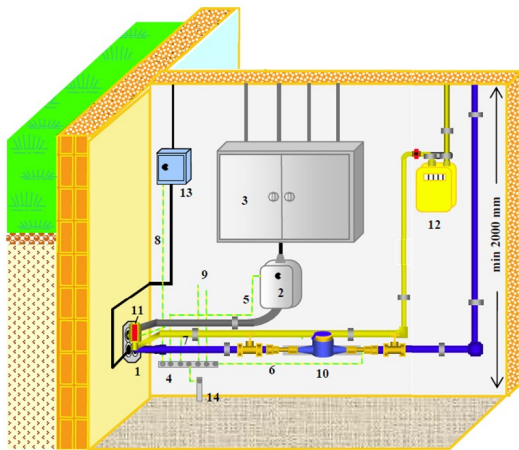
Gemeinsame Hausanschlussstrasse auf dem Privatgrundstück
